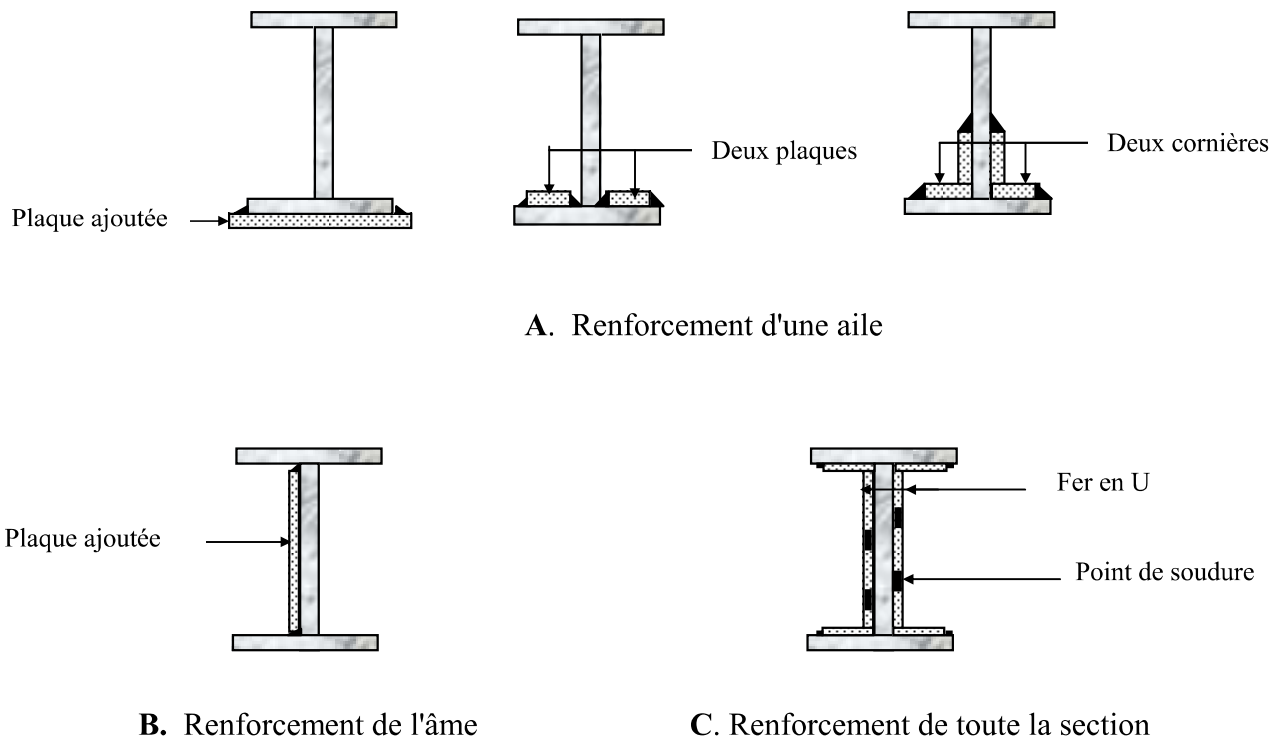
Détails de mise en place de renforts de poutre à larges ailes.
